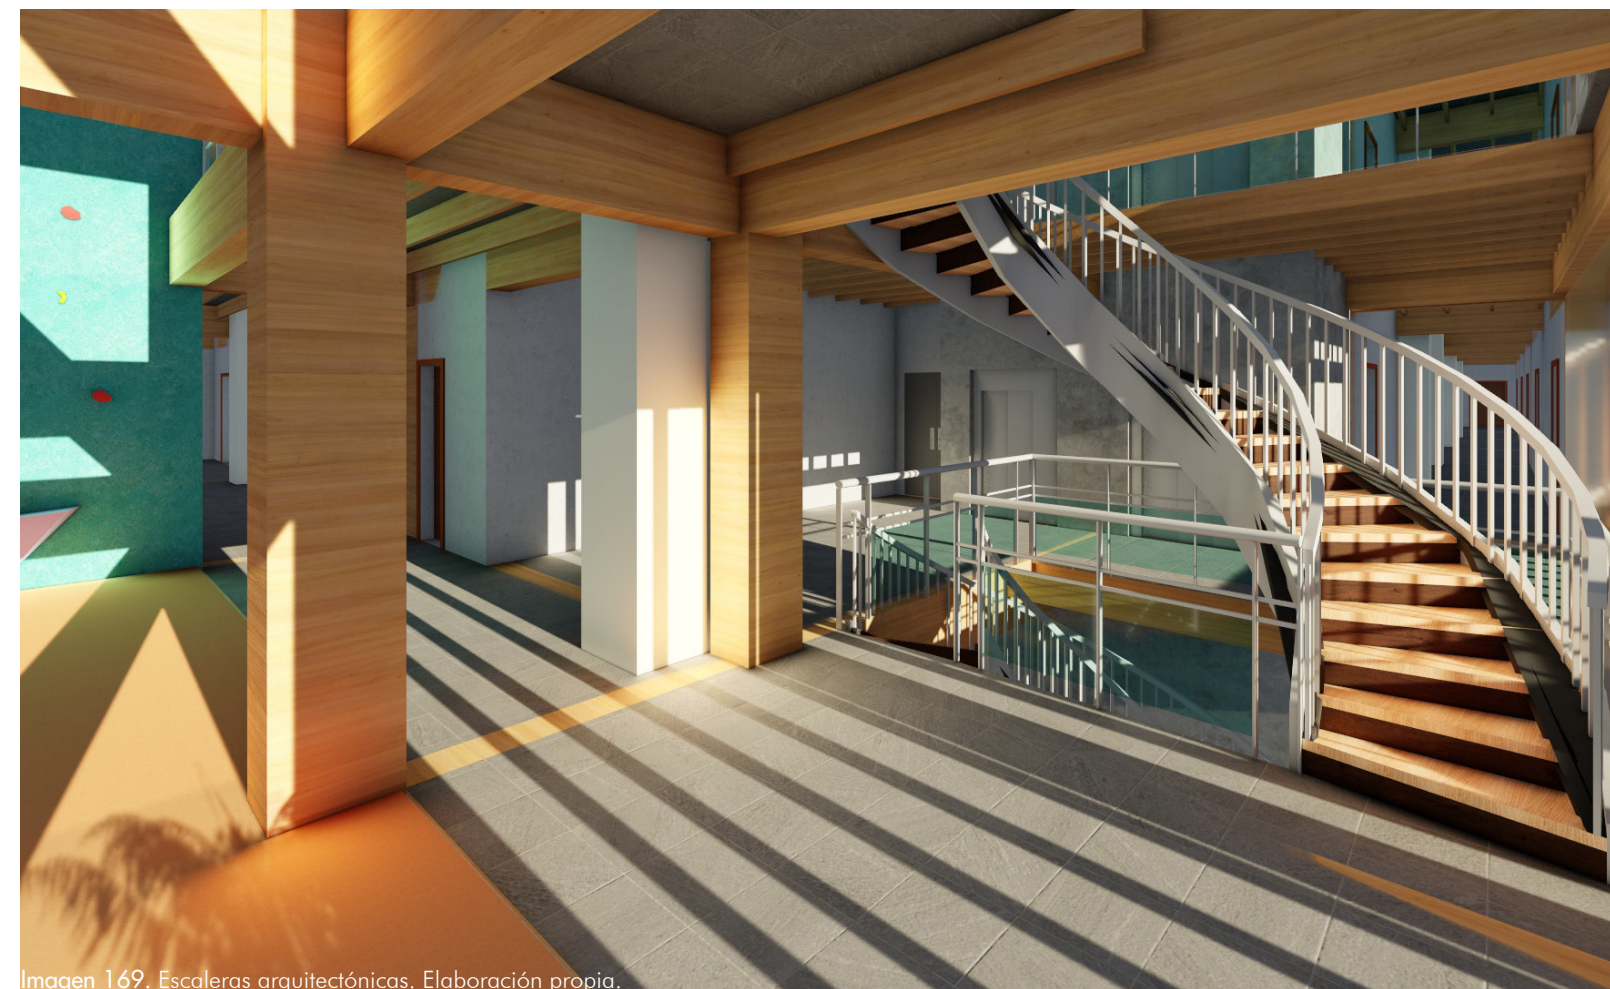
Escaleras arquitectónicas. Elaboración propia.
